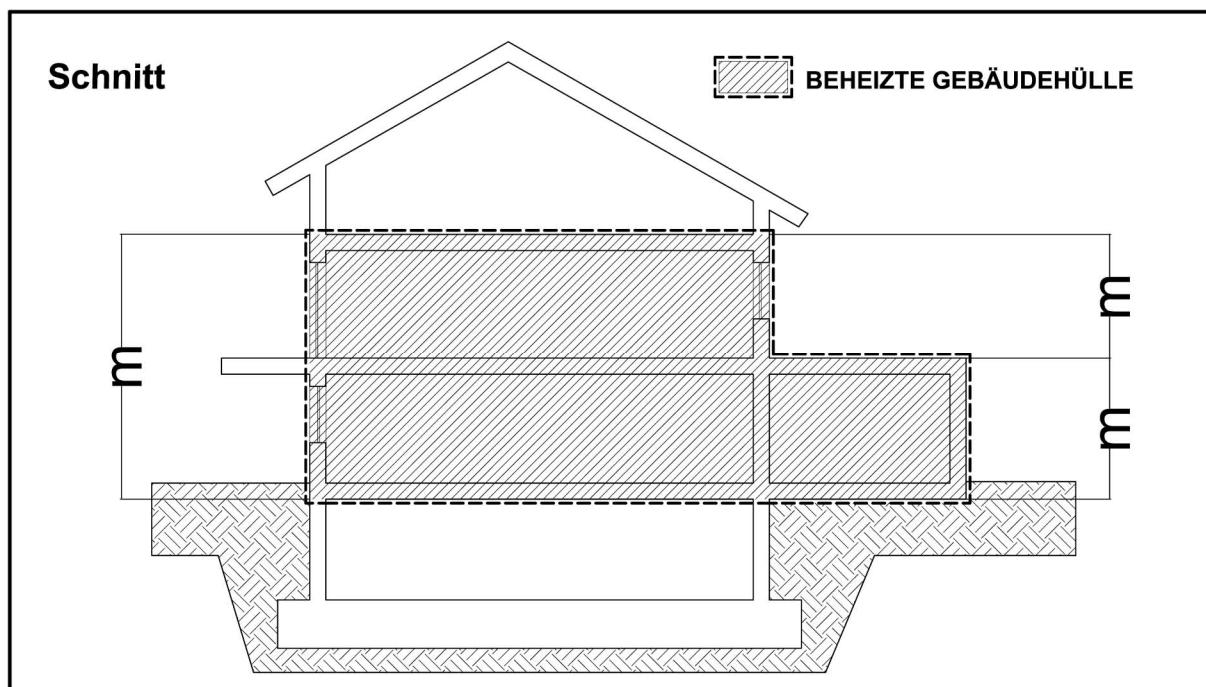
anzusetzende Bruttogeschosshöhe/-gebäudehöhe der wärmeübertragenden Umfassungsflächen
